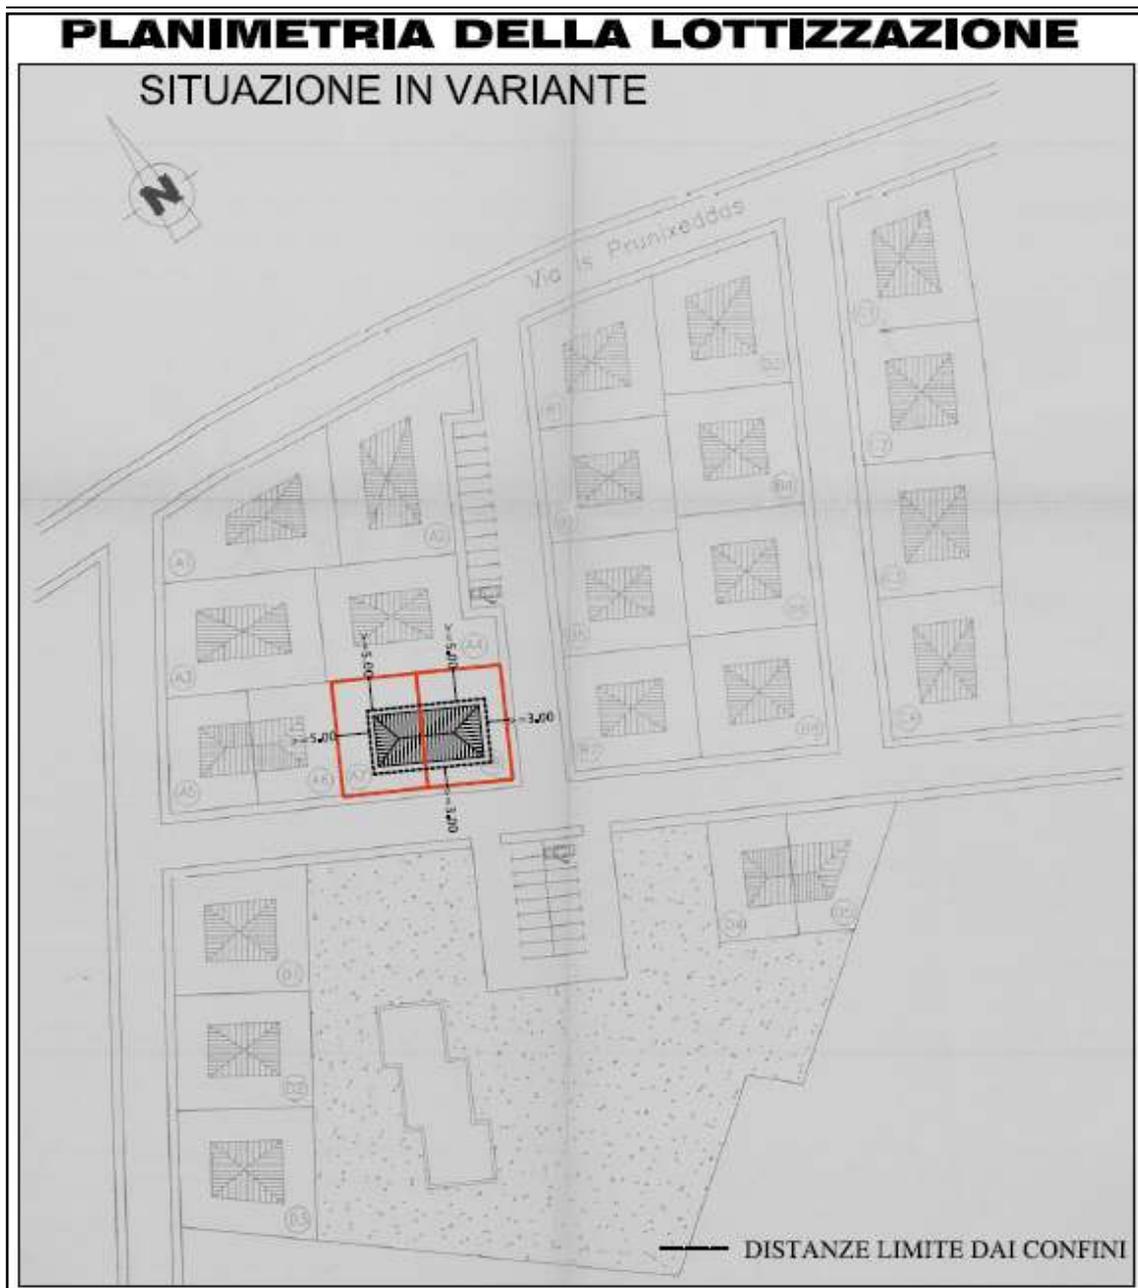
Lotto oggetto di variante così come previsto nella variante.
